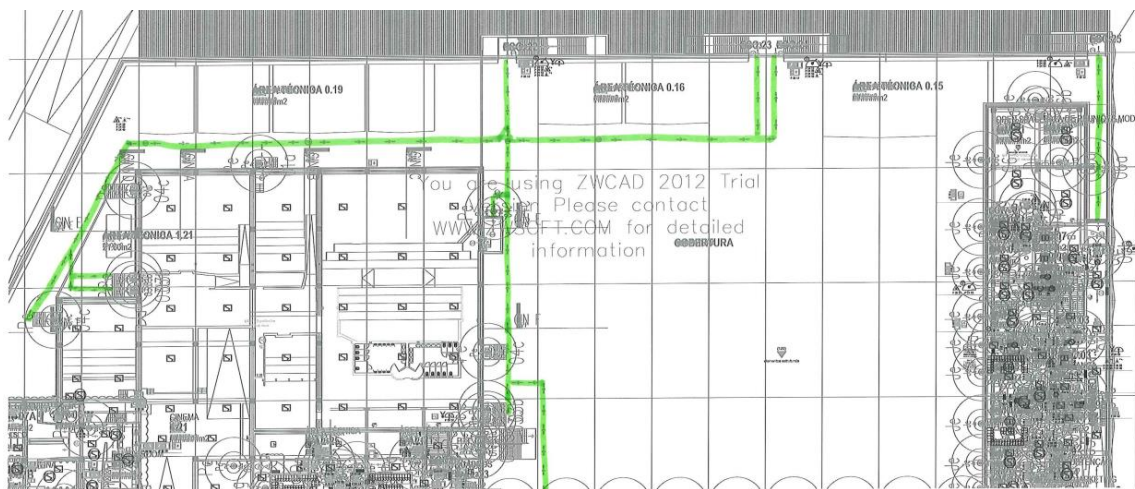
Planta com os caminhos de evacuação no Piso 1
